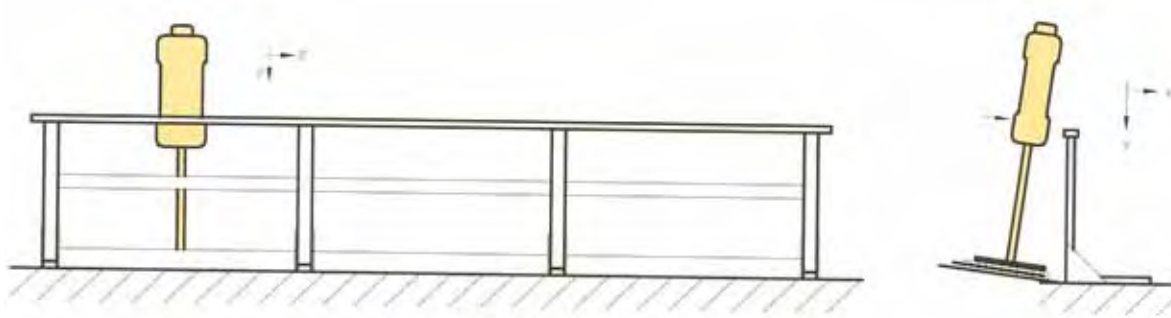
Essais dynamiques sur la lisse supérieure de la section de rive d’une suite de trois travées de garde-corps ancrées au parapet.
